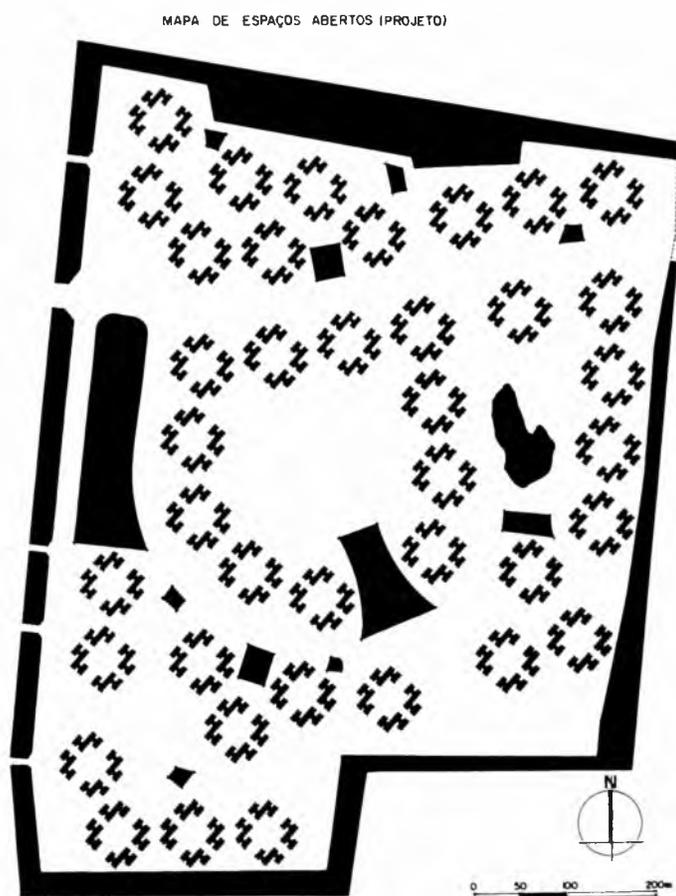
Planta de espaços públicos – em branco – do projeto do Conjunto Rubem Berta e dos espaços privados – em preto
